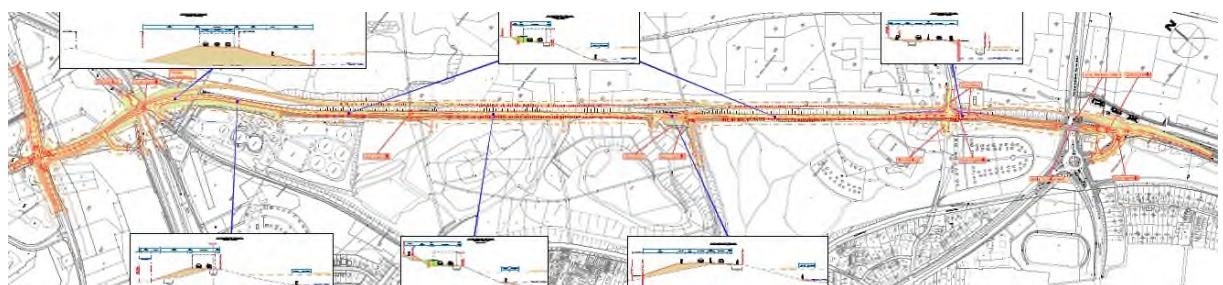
Vorzugsvariante mit Querprofilen
